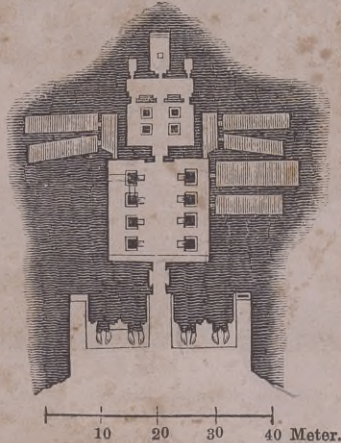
Grundriss und Fig. 49 Durchschnitt des Felsentempels zu Ipsambul mit einer der vier vor dem Eingang aus dem Felsen gehauenen
